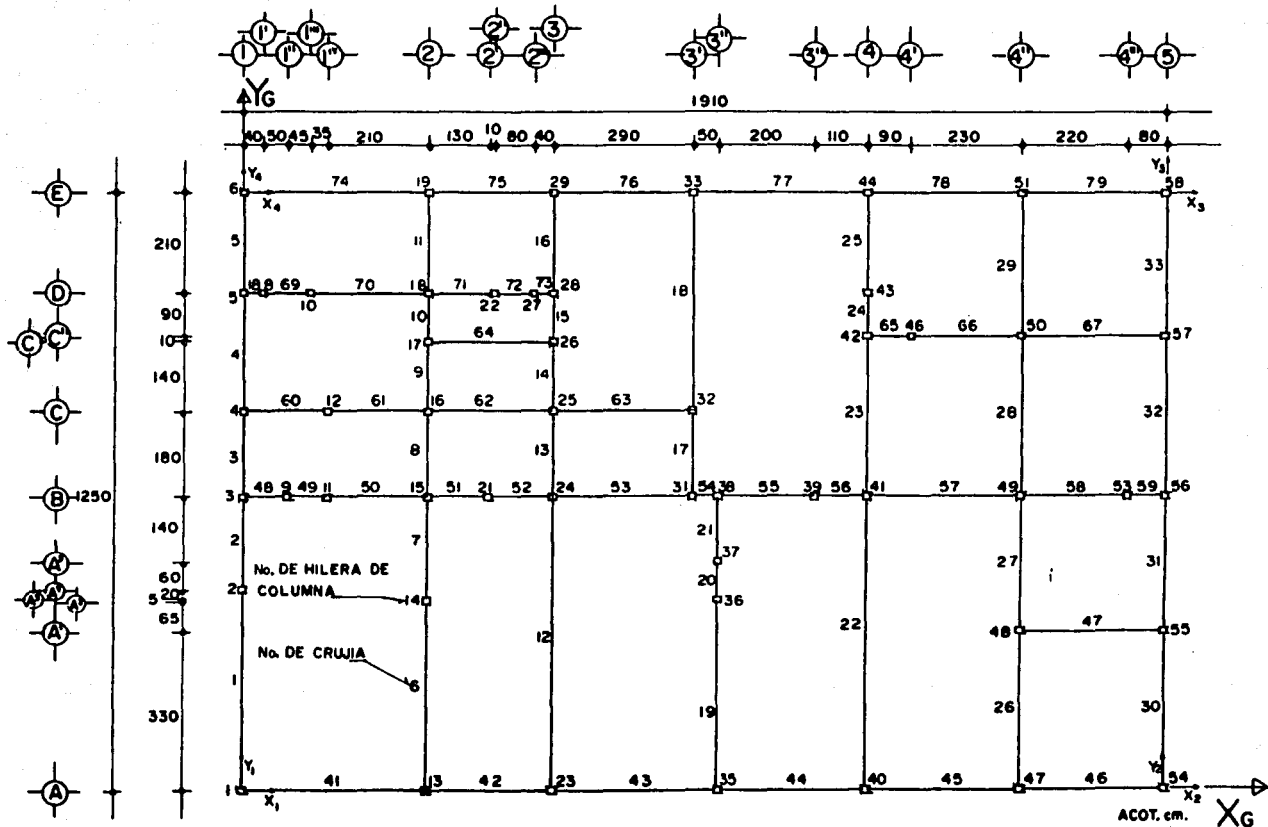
IDEALIZACION DE LA ESTRUCTURA.
